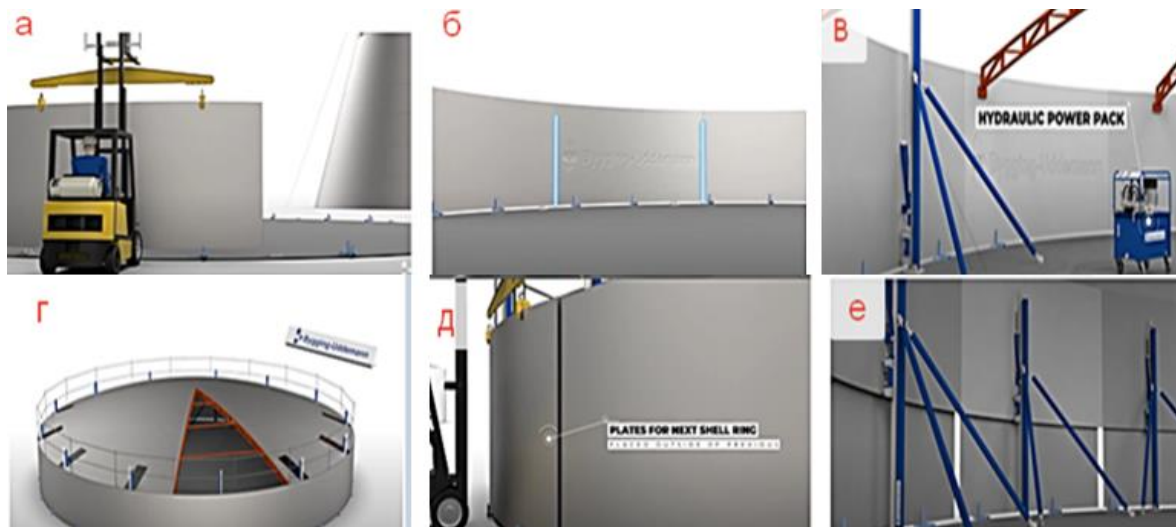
Некоторые технологические процессы полистовой сборки вертикальных стен с применением шагающих домкратных устройств: а — подача листов грузоподъемным механизмом и сборка верхнего (первого) пояса; б — сварка вертикальных листовых конструкций верхнего (первого) пояса; в — монтаж шагающих домкратов и ферменных конструкций крыши; г — окончание монтажа конструктивных элементов крыши и ограждения на крыше; д — подача листов грузоподъемным механизмом и подрачивание последующего (второго с верха) пояса; е — процесс подъема верхнего (первого) пояса с помощью шагающих домкратов (<https://yandex.ru/video/preview/?filmId=12259737609334286614&from=tabbar&parent-reqid=1647782772204519-12567657400026876364-sas3-0749-7ac-sas-17-balancer-8080-BAL-197&>)
